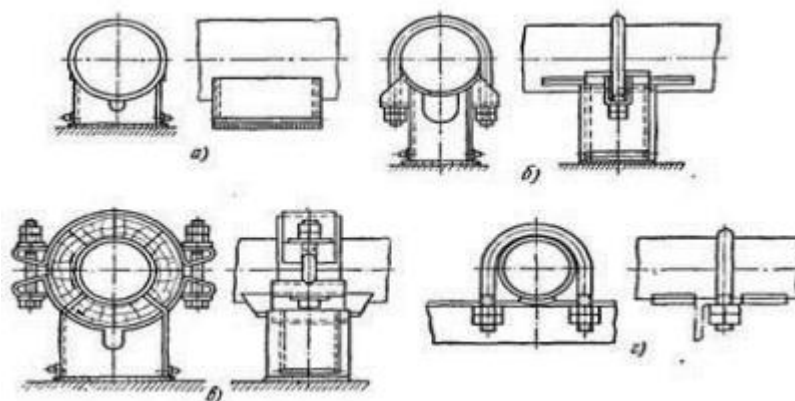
Конструкции неподвижных опор трубопровода, где: а – приварная; б – хомутовая; в – хомутовая для трубопроводов с хладагентом; г – бескорпусная.
